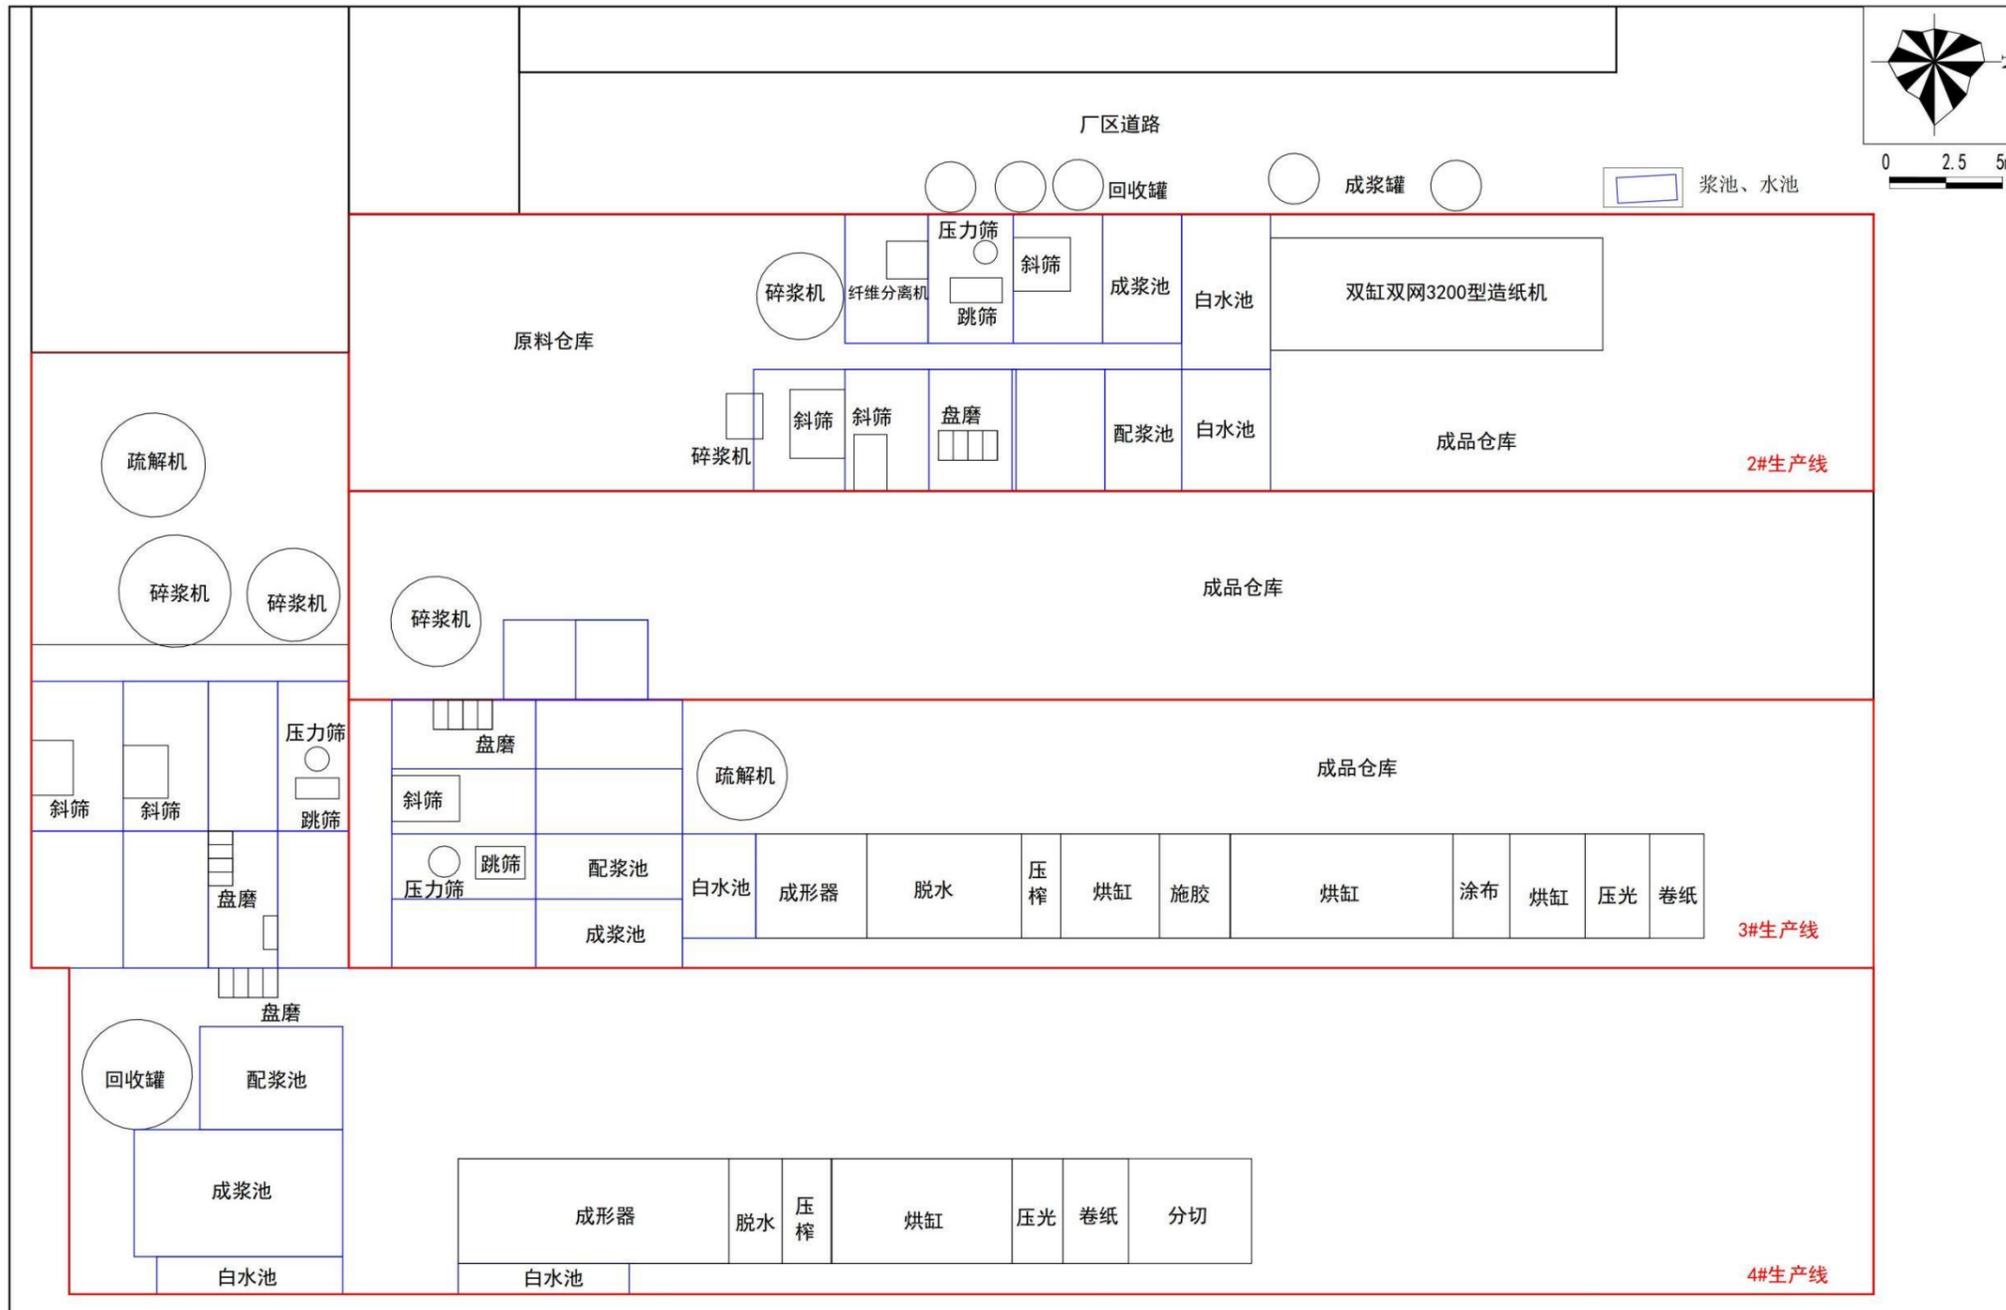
改建前工程 2#、3#、4#生产线平面布置图
